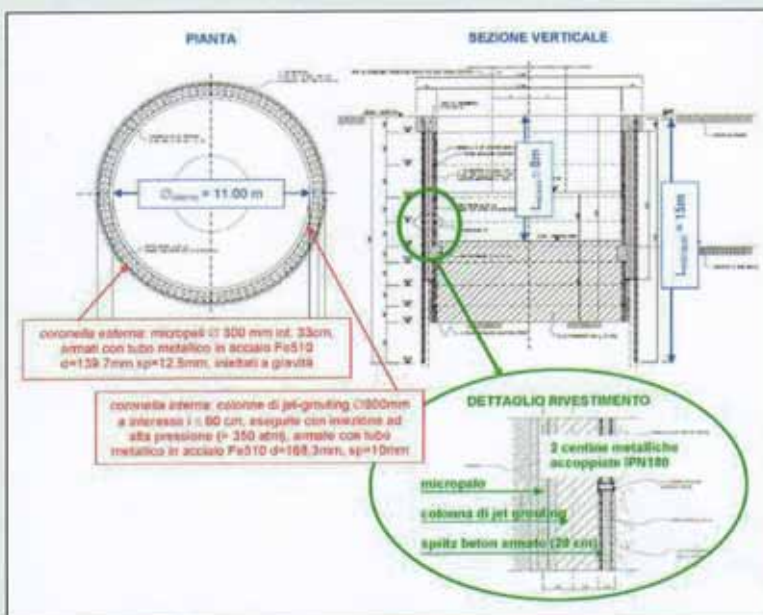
La coronella doppia in micropali e colonne di jet-grouting
